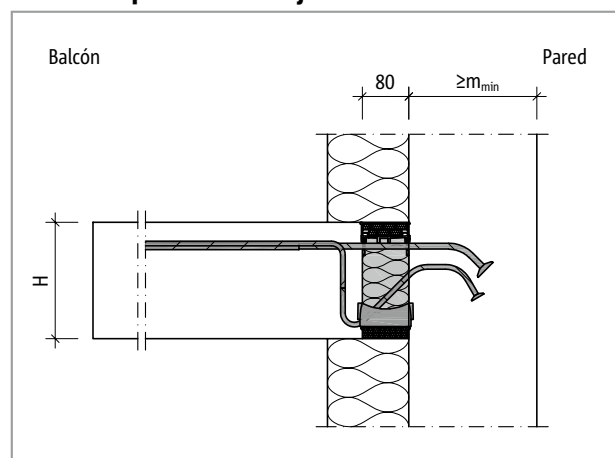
Schöck Isokorb® T tipo K-O: Conexión a pared hacia abajo en caso de aislamiento externo
